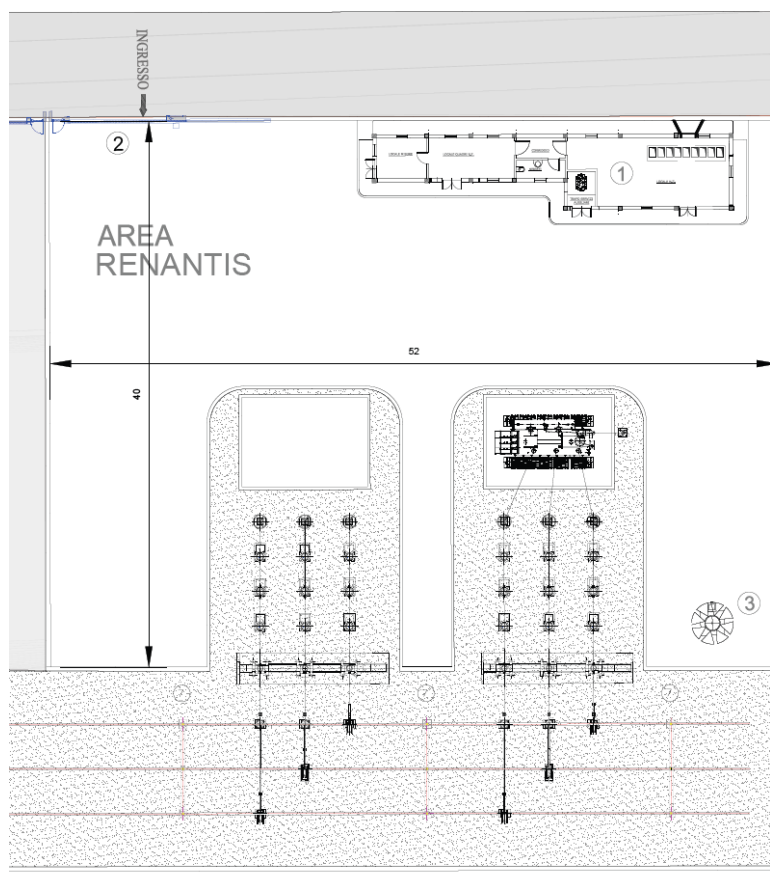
Planimetria elettromeccanica della Stazione Trasformazione Renantis
